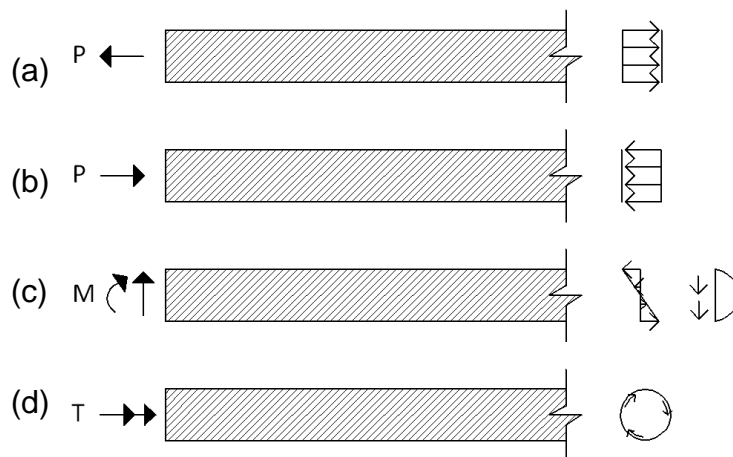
Tipos de hastes, (a) tirante, (b) coluna, (c) viga, (d) eixo da torção. Fonte: Pfeil e Pfeil (2009, p.25).
